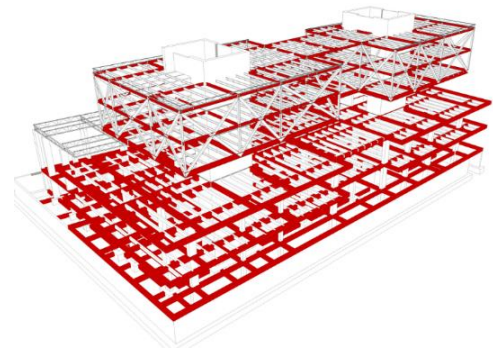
Axonometría Estructural- Vigas Estructurales.
